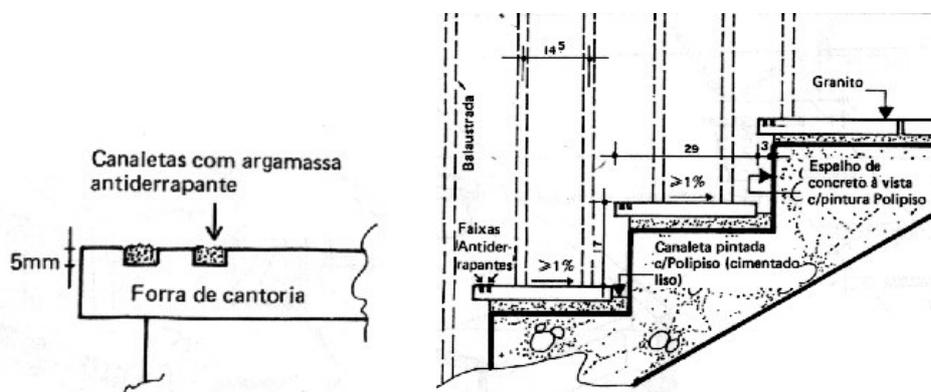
Detalhes construtivos para execução de escadas externas de concreto.
